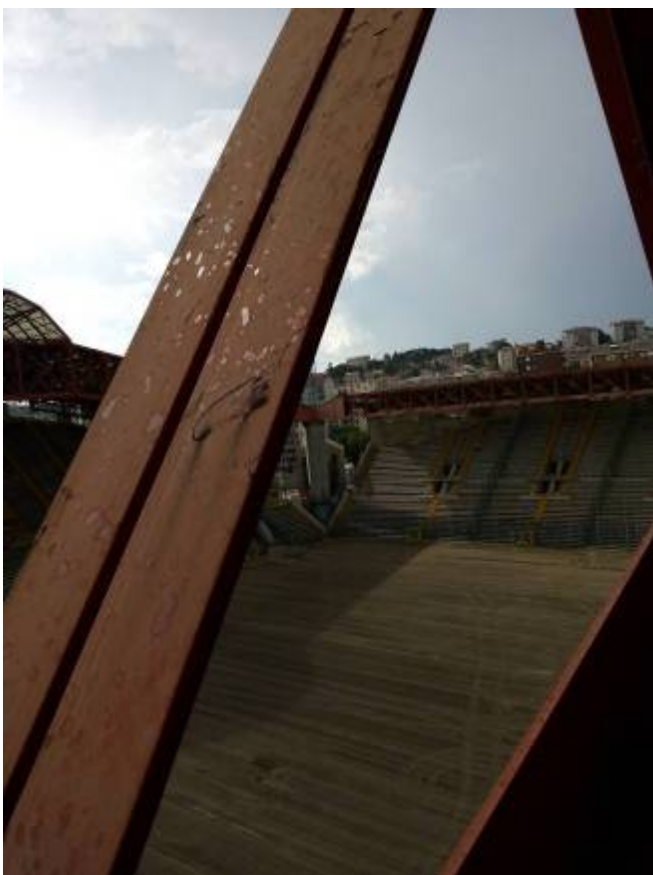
e 16: degrado tipo riscontrato sugli elementi metallici delle aste di parete travi rosse
